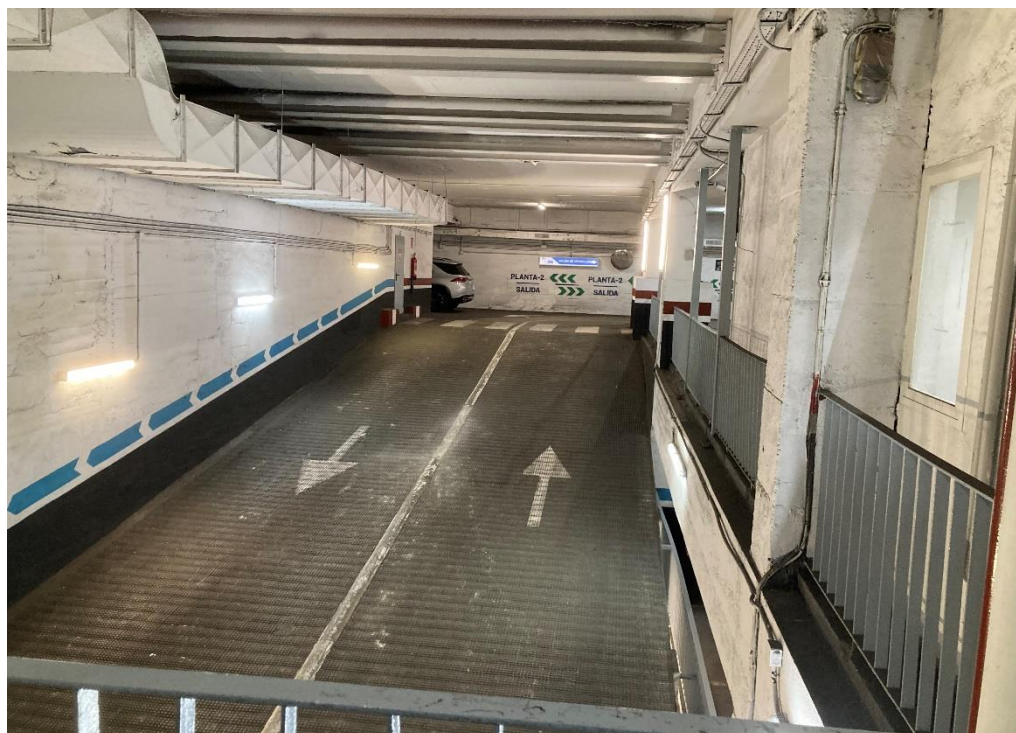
Vista general planta S-1. Desgaste de pavimento
